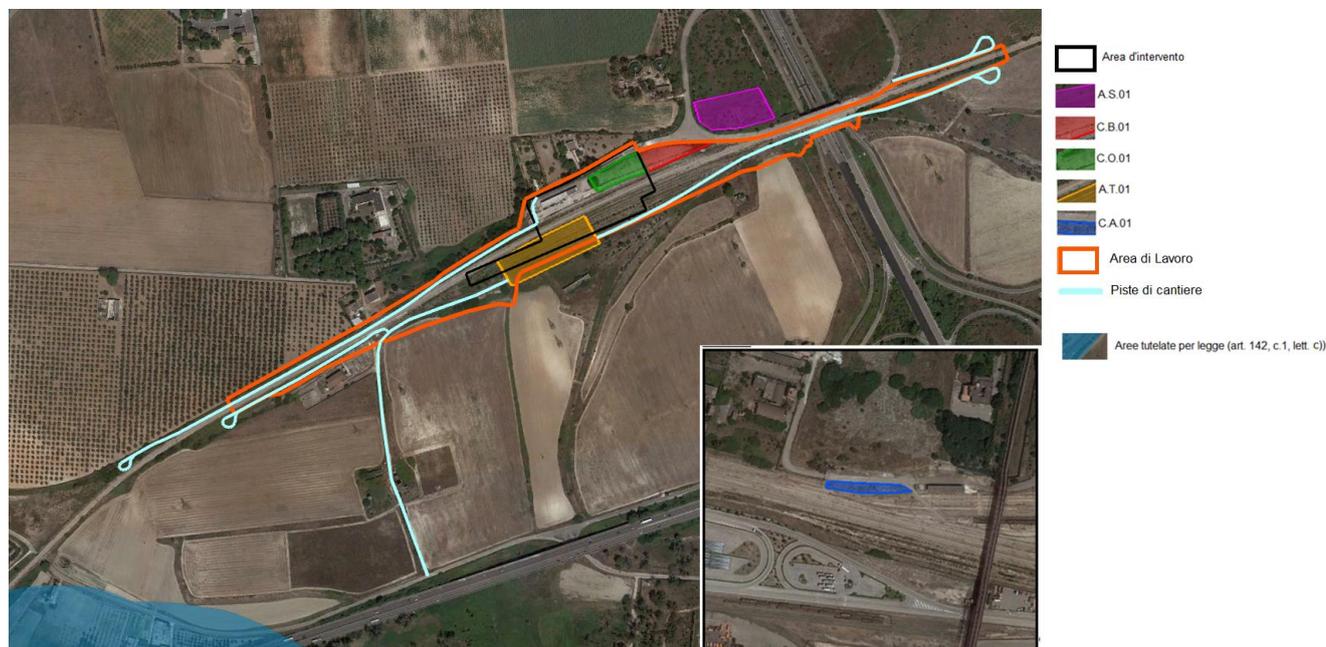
Localizzazione dell'area d'intervento e delle aree di cantiere rispetto il vincolo
